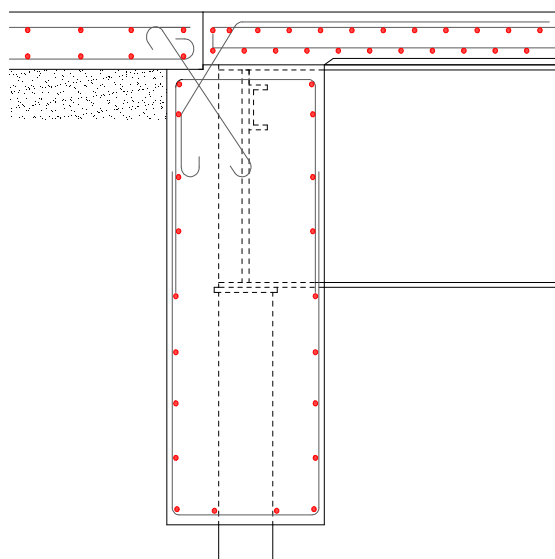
Connessione sovrastruttura in acciaio – spalla, *schema 3
